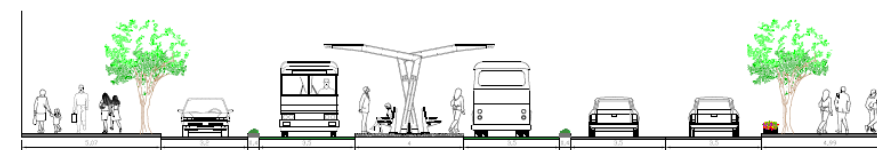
Planta y sección andén en la intersección de la Casa del Mar.
